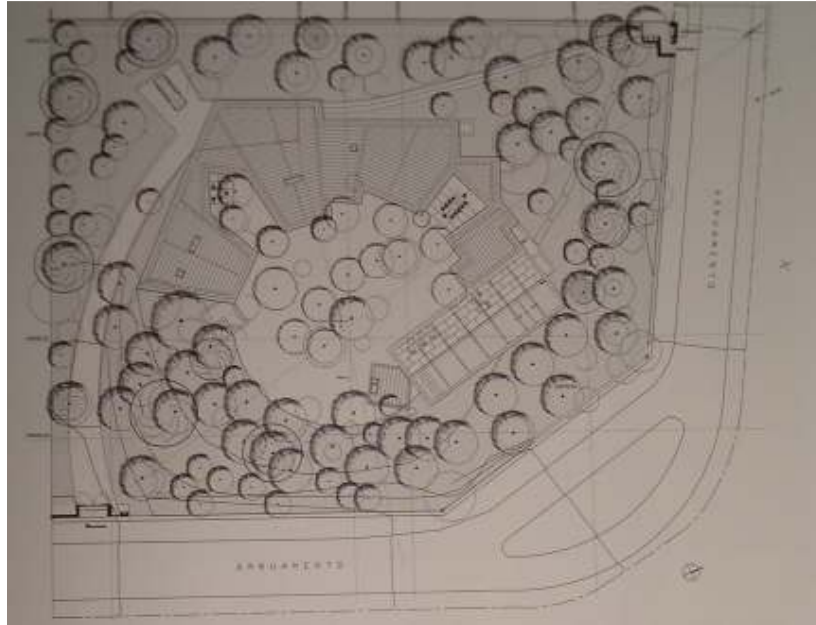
Croqui da implantação do projeto no terreno. Fonte: ELCROQUI (2009)
